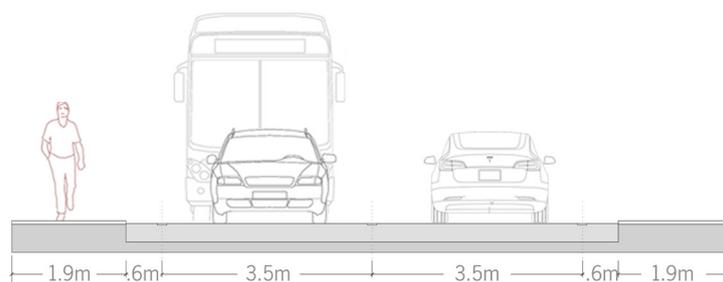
Perfil geral da avenida do Cávado de 12 metros
